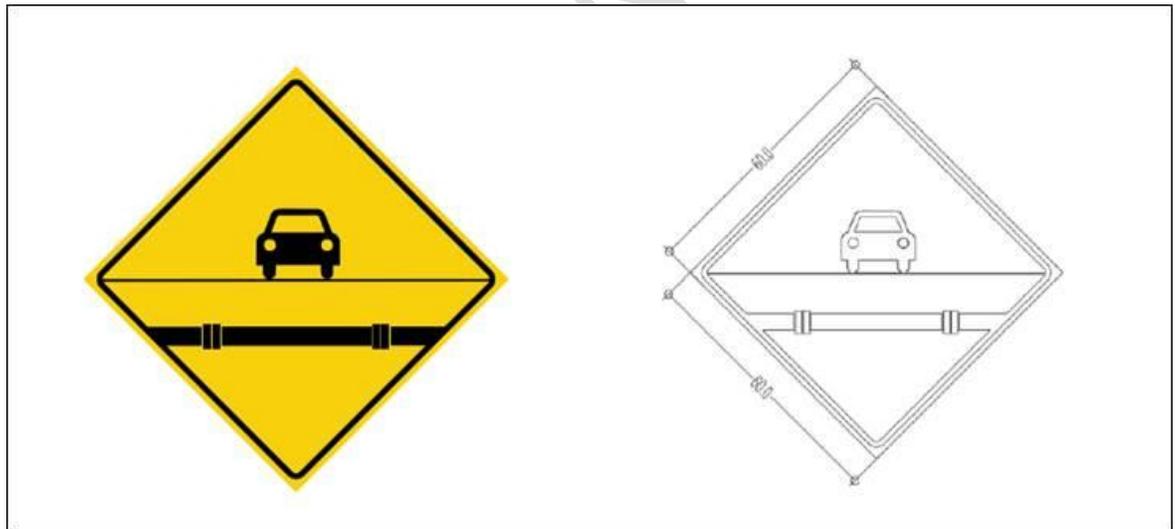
Señal terrestre para cruce vial (tablero superior).
